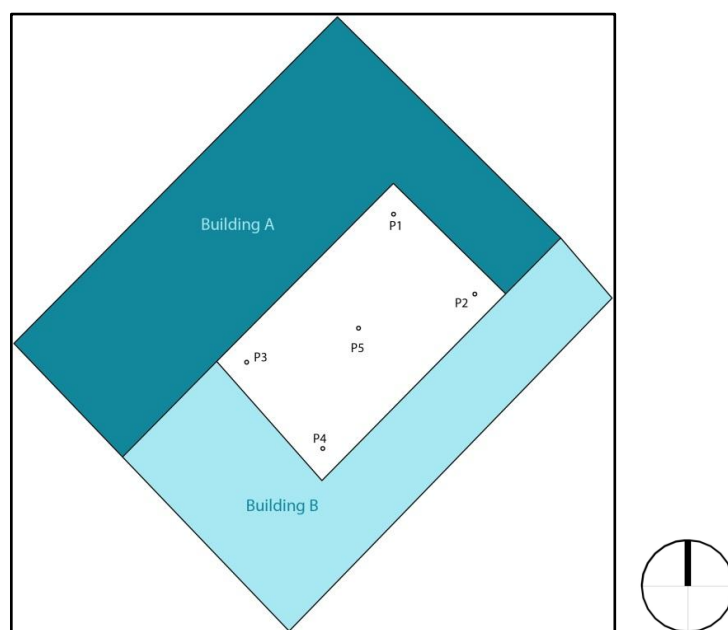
Pianta delle casa a corte ed indicazione delle persone
